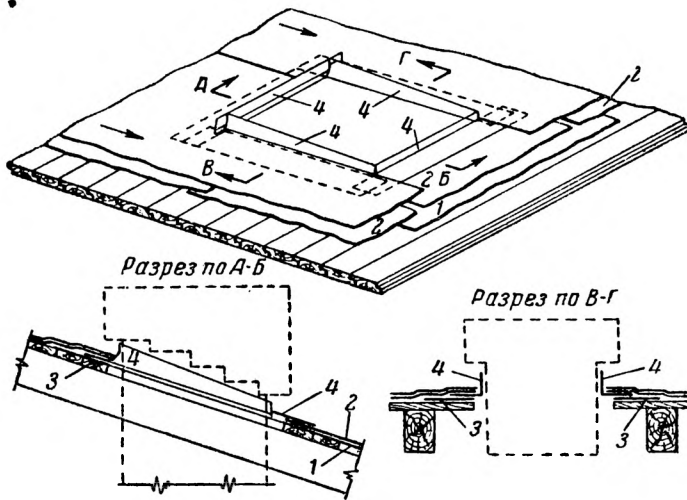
Примыкание рулонного покрытия к дымовой трубе:
